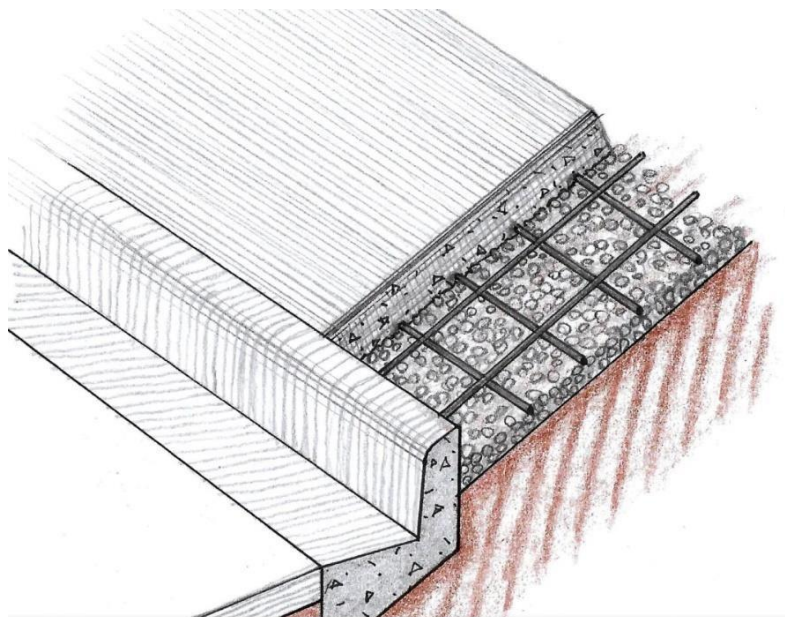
Detalhe esquemático para execução de calçada em concreto armado.
